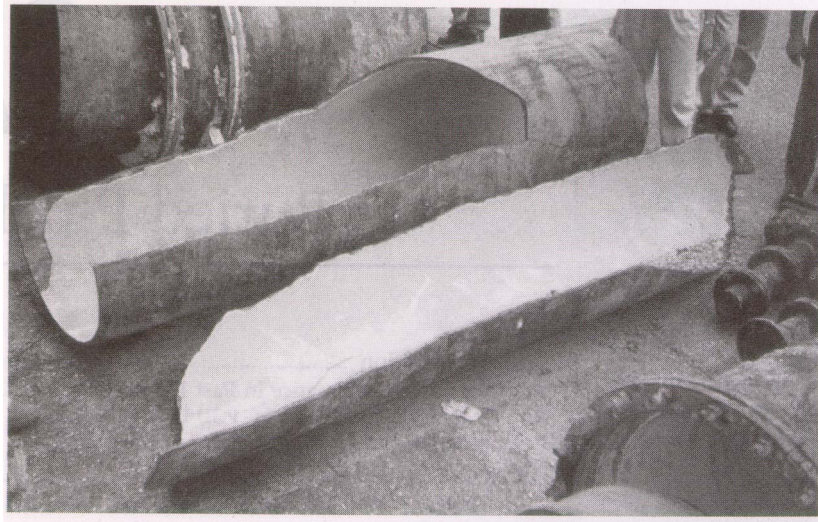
Bruch einer Frischwasserleitung durch das Kobe-Erdbeben [Chen 03].
